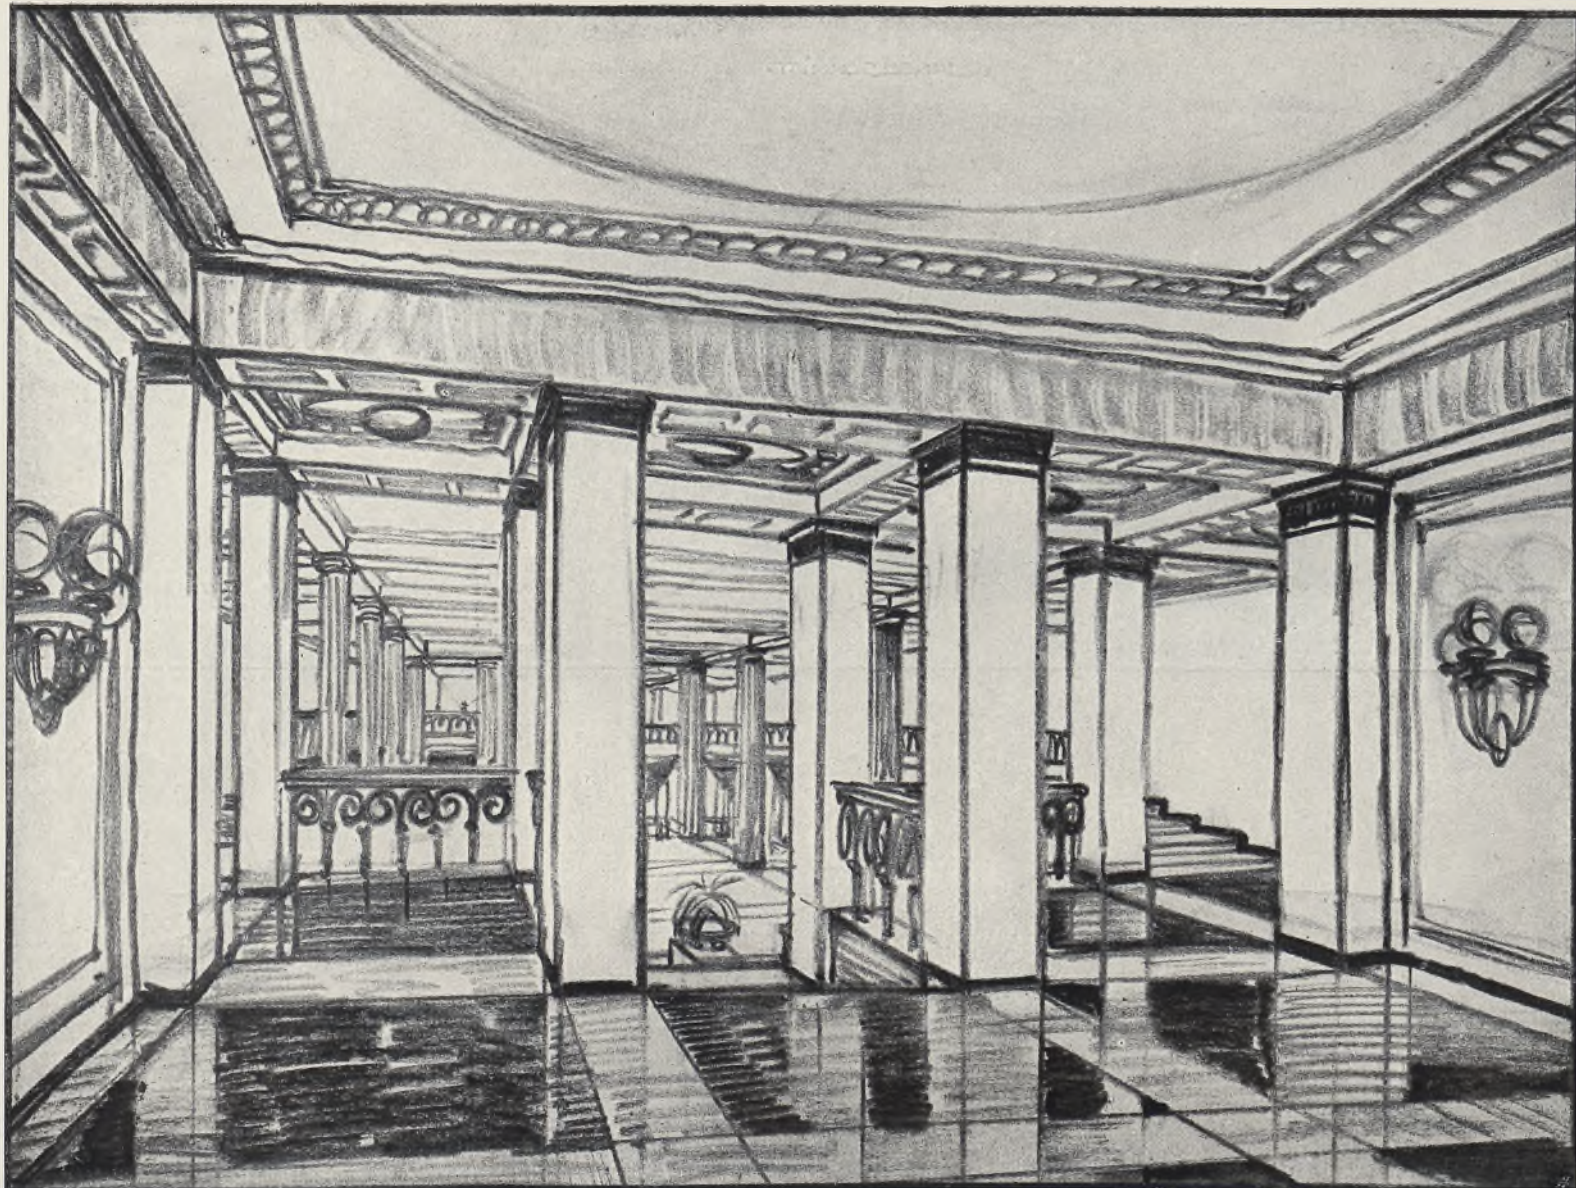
Peter Behrens, Hotelprojekt, Blick von der Eingangshalle in die große Halle im vertieften Erdgeschoß.
